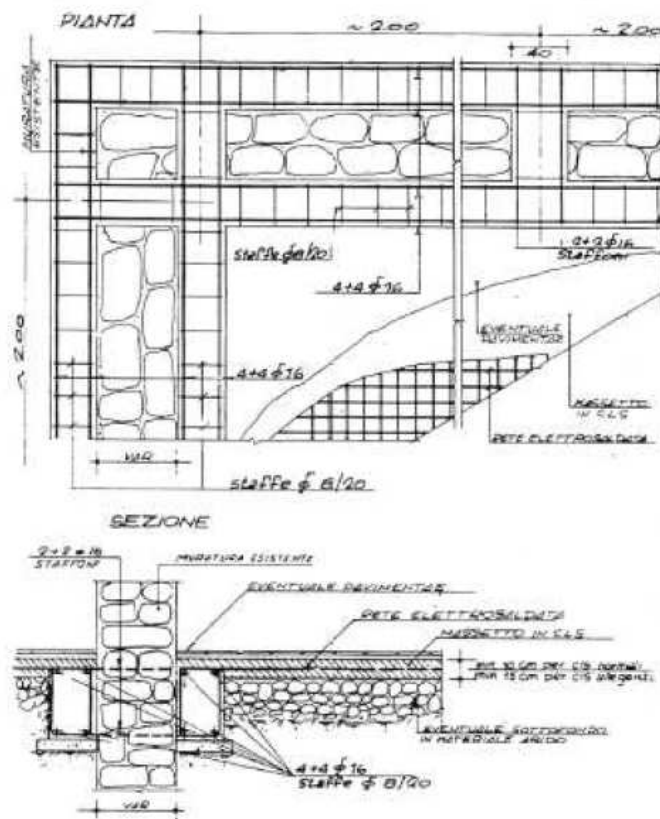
Rinforzo della fondazione con cordoli in c.a., massetto e rete elettrosaldata
